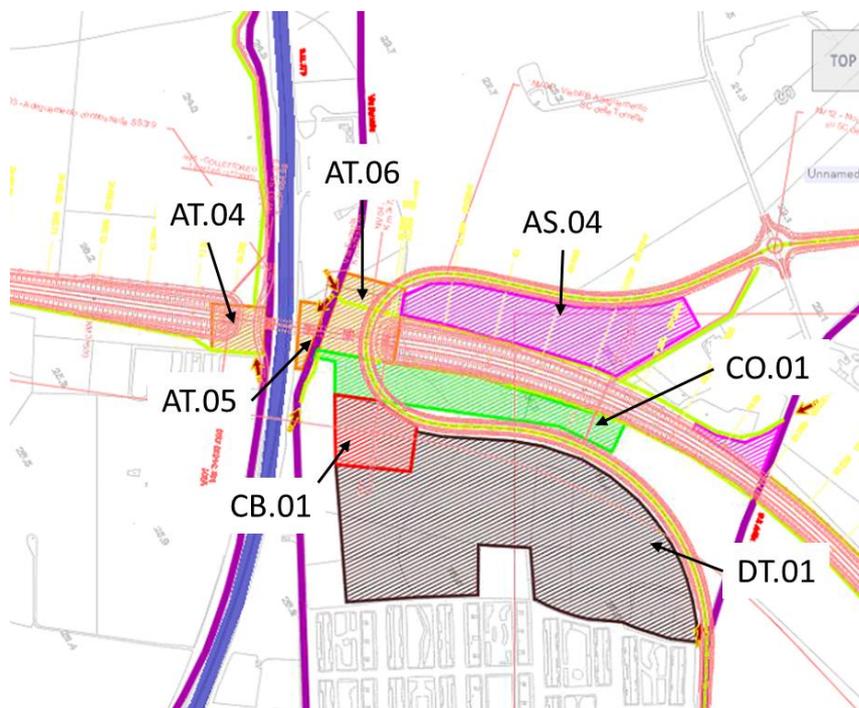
Localizzazione delle aree di cantiere e attività di lavorazione
